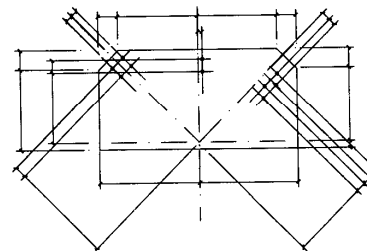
非焊接节点板尺寸的标注方法
